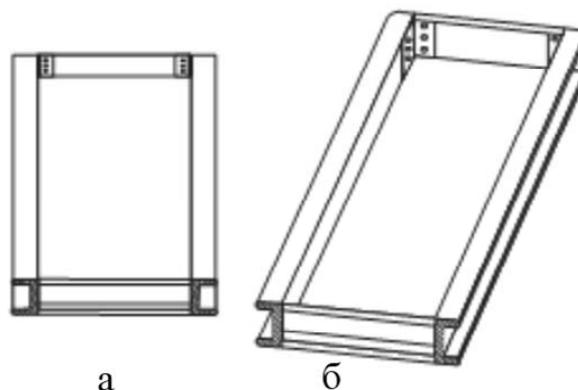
Опалубка для ремонта железобетонных пролетных строений мостов с использованием мобильной разрядно-импульсной установки (а – общий вид; б – крепление соединяемых швеллеров)
